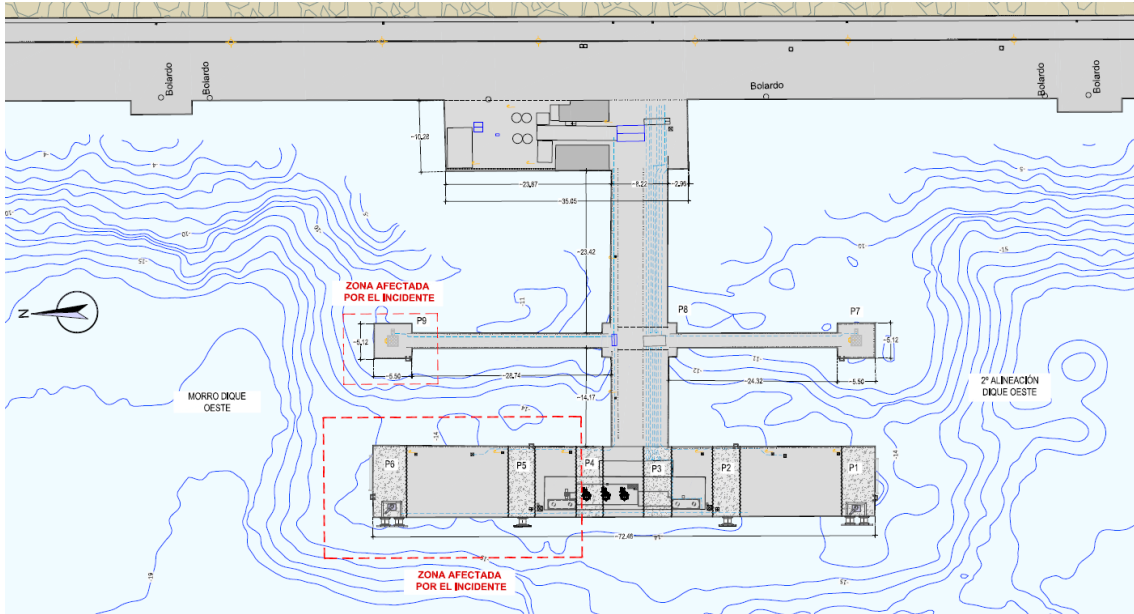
Planta del Terminal de EXOLUM con las pilas dañadas identificadas.
